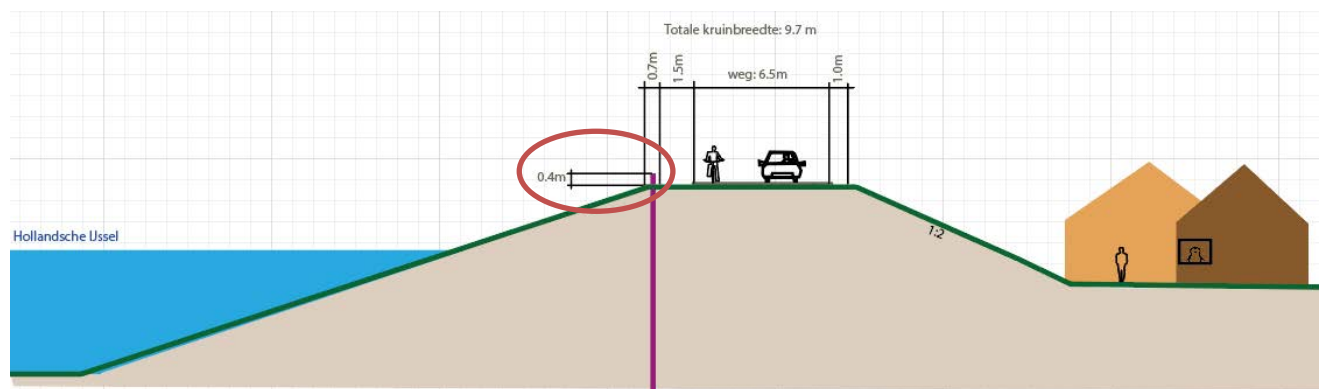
situatie met een minimale kruinbreedte en hoogte type I constructie 75cm
